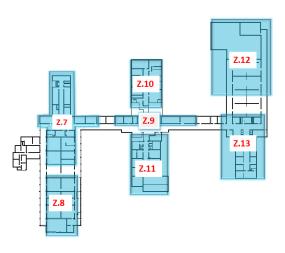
Ubicación de las Zonas (7 - 13) en Primer Piso Fuente: Autores
